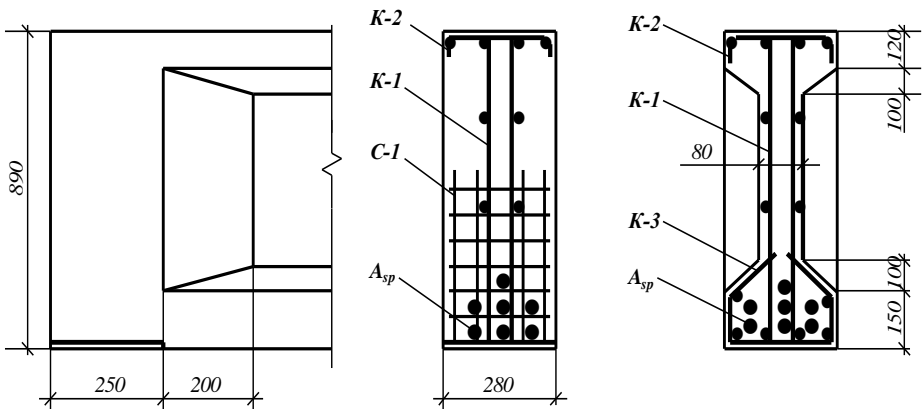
Конструювання балки покриття з паралельними поясами
